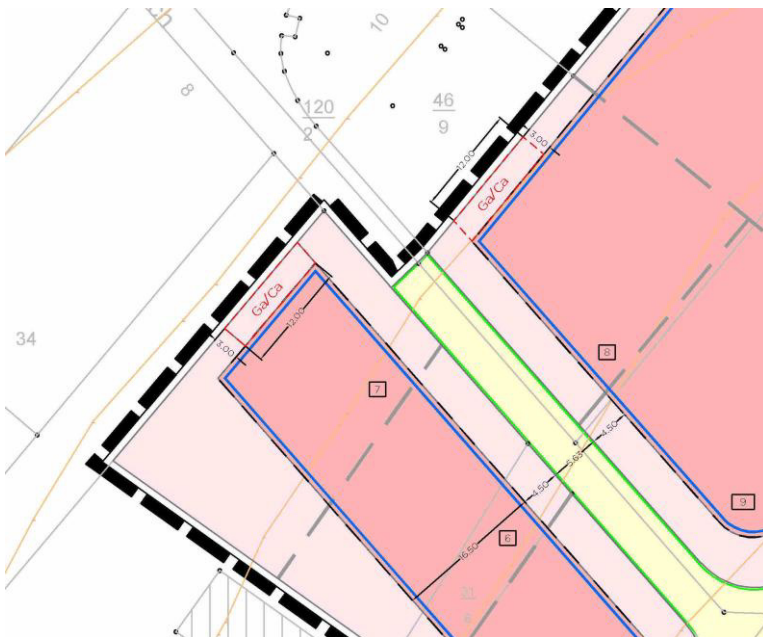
Ausschnitt B-Plan „Am Holzapfelbaum III“ Nordwest
